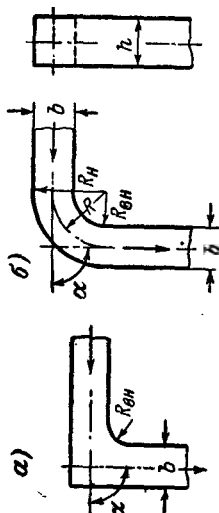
Схемы поворотов: а — резкий (колени); б — плавный нормальный (отвод)
